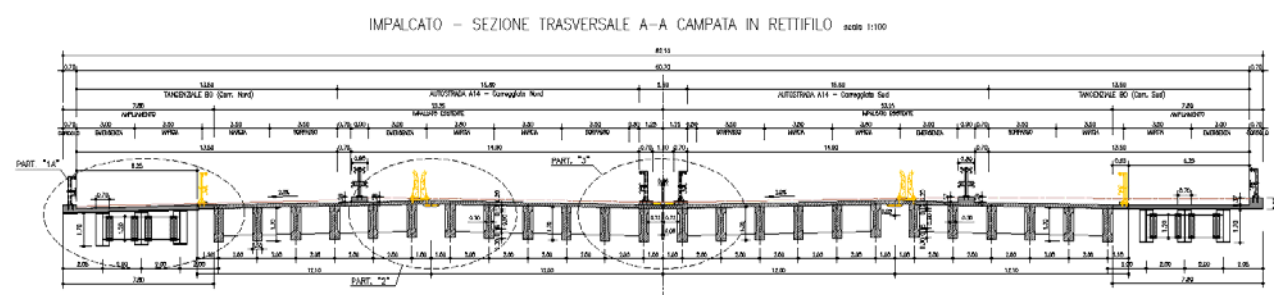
Sezione tipo di progetto ponte sul fiume Reno (fonte: *Progetto definitivo – Relazione generale*)
